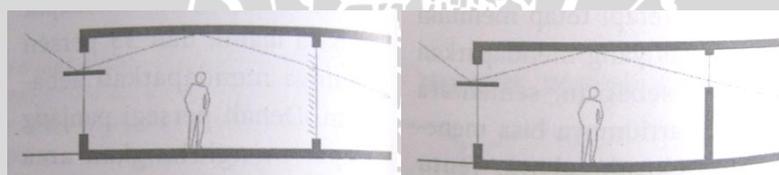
Beberapa Denah Lantai Bangunan dan tinggi jendela yang Menggambarkan Efek Kepadatan Cahaya Alami
